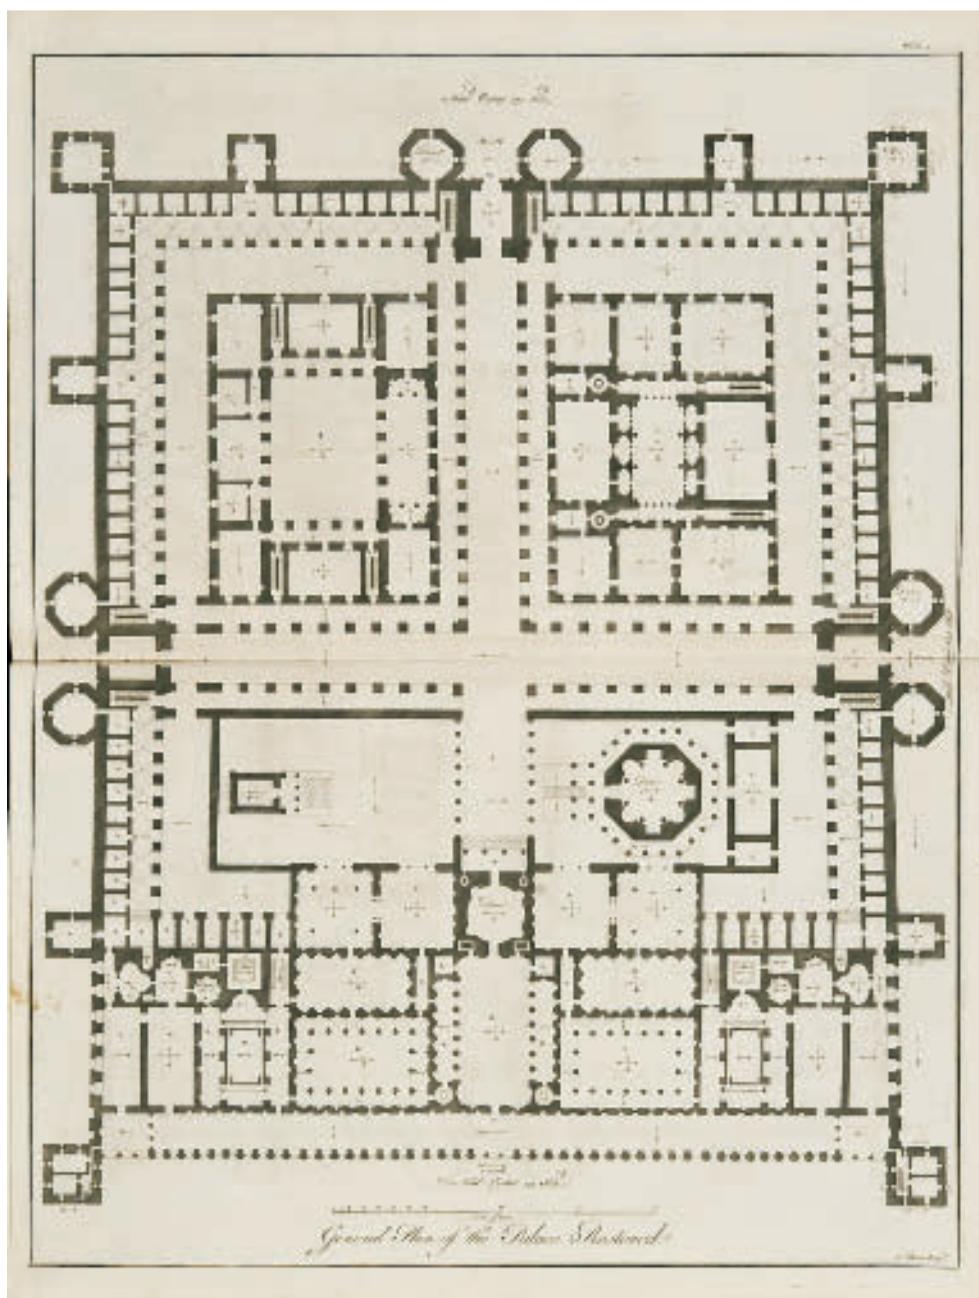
«Plan general del Palacio restaurado» (Lámina VI, Adam. R.: *Ruins of the Palace* ..., Londres, 1764)
